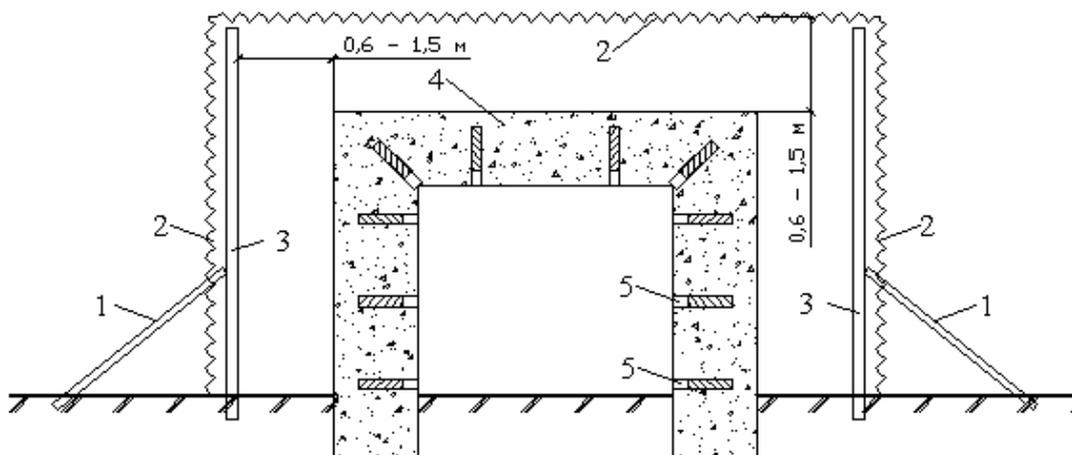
Схема укрытия бетонного тоннеля металлической сеткой для предотвращения разлета осколков: 1 – распорки; 2 – сетка; 3 – поддерживающие столбы; 4 – бетонный тоннель; 5 – шпуровые заряды
